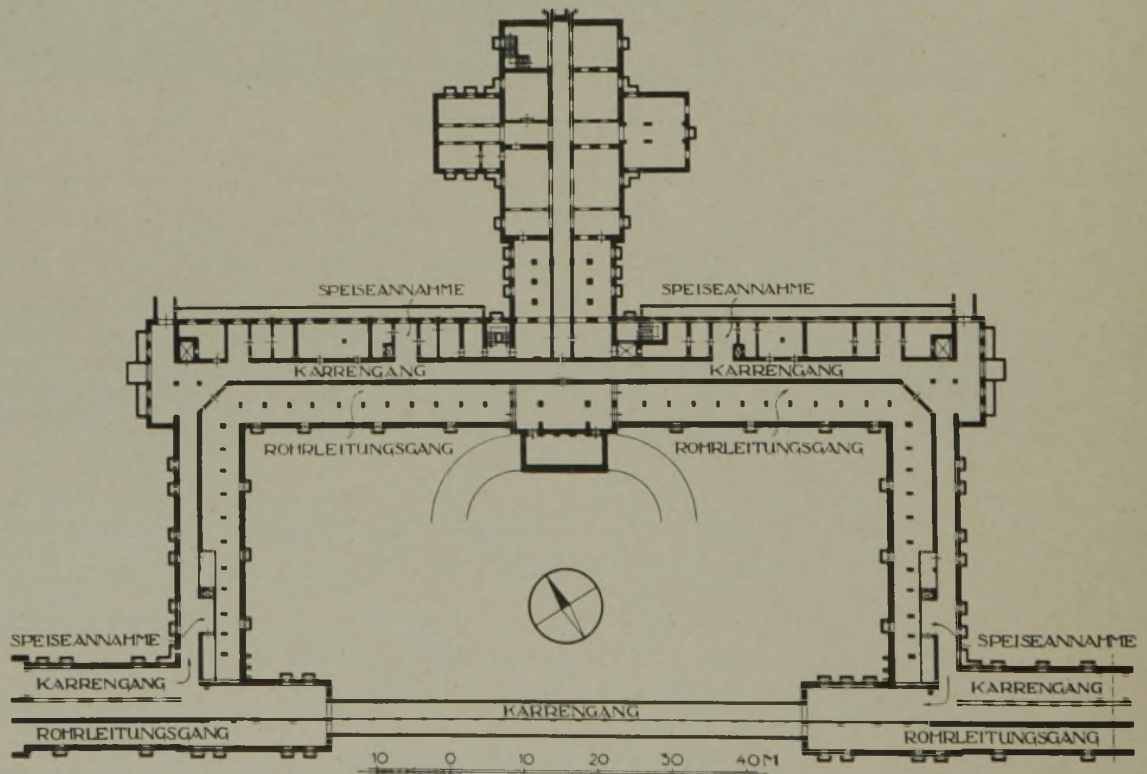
Grundriß des Kellergeschosses. (M. 1 : 1000.)
